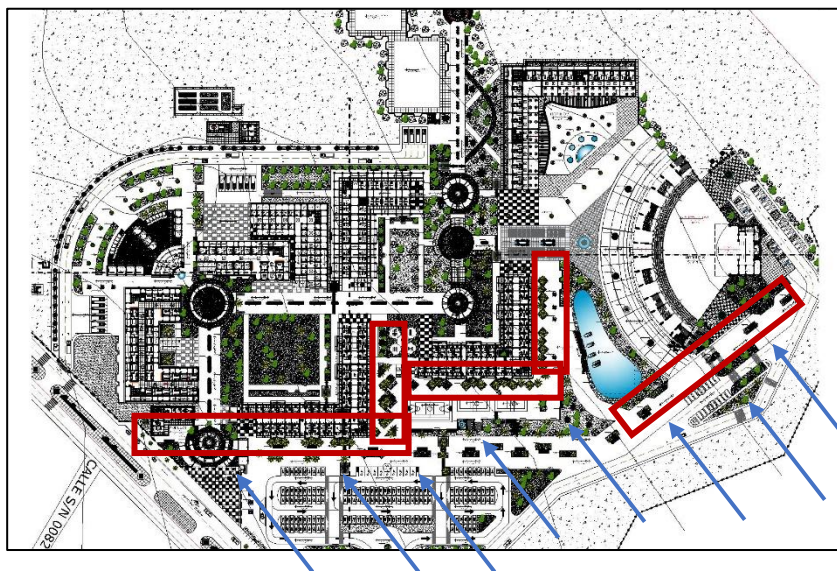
Elementos de protección de aire- barreras vegetales
